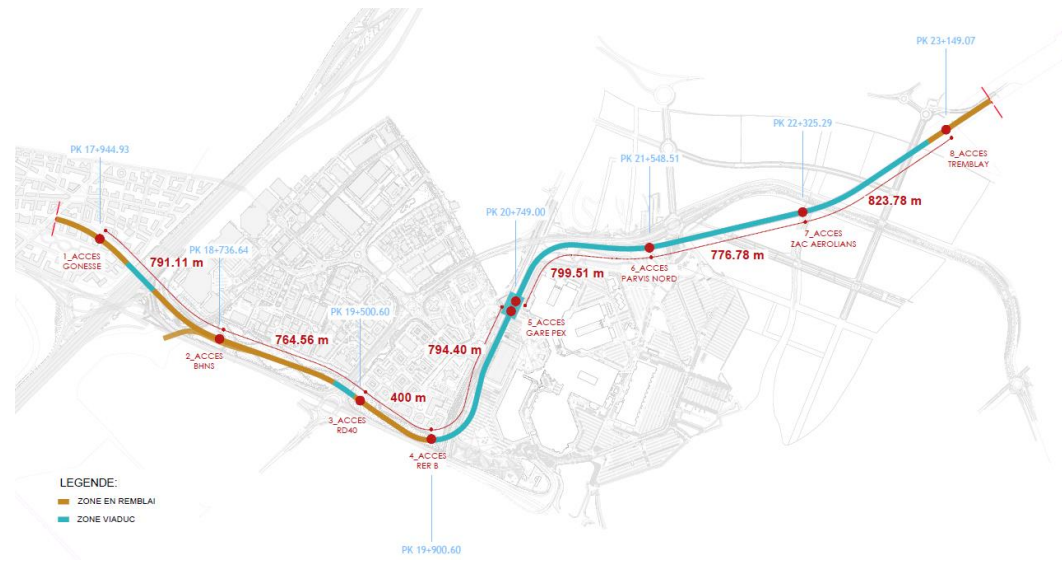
Plan de positionnement des accès de secours de la section aérienne
